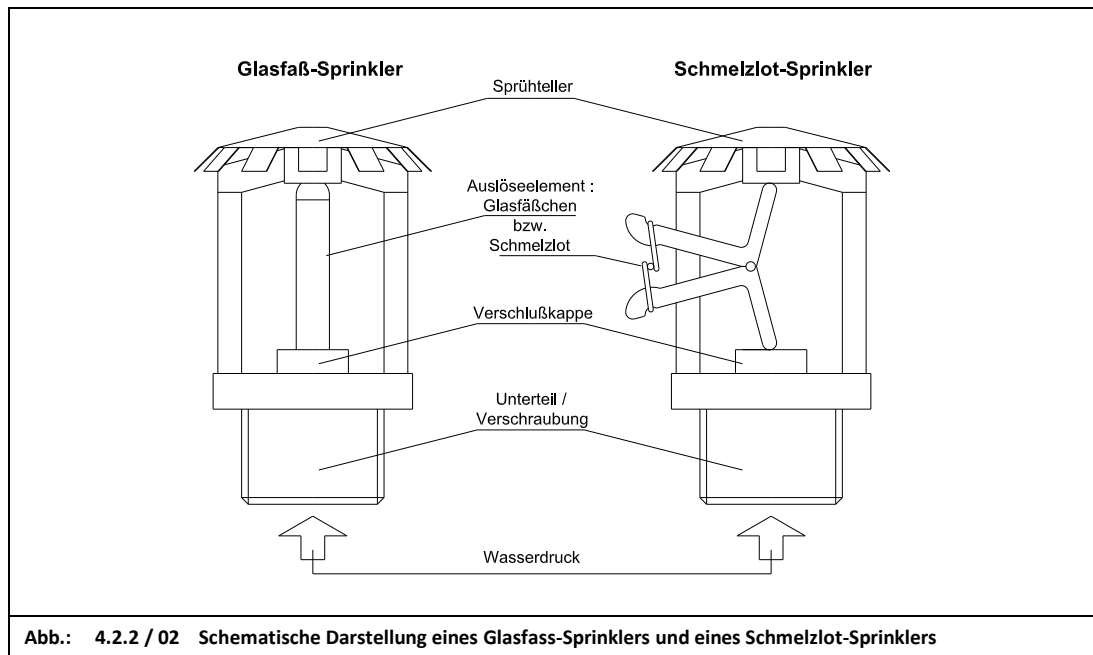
/ 02 Schematische Darstellung eines Glasfass-Sprinklers und eines Schmelzlot-Sprinklers
